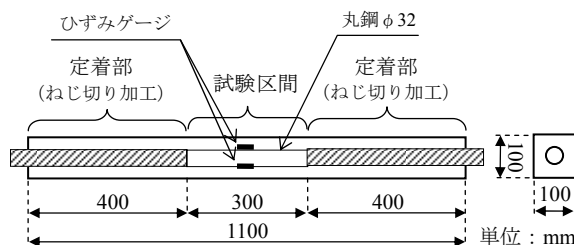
収縮ひび割れ評価試験供試体の形状
